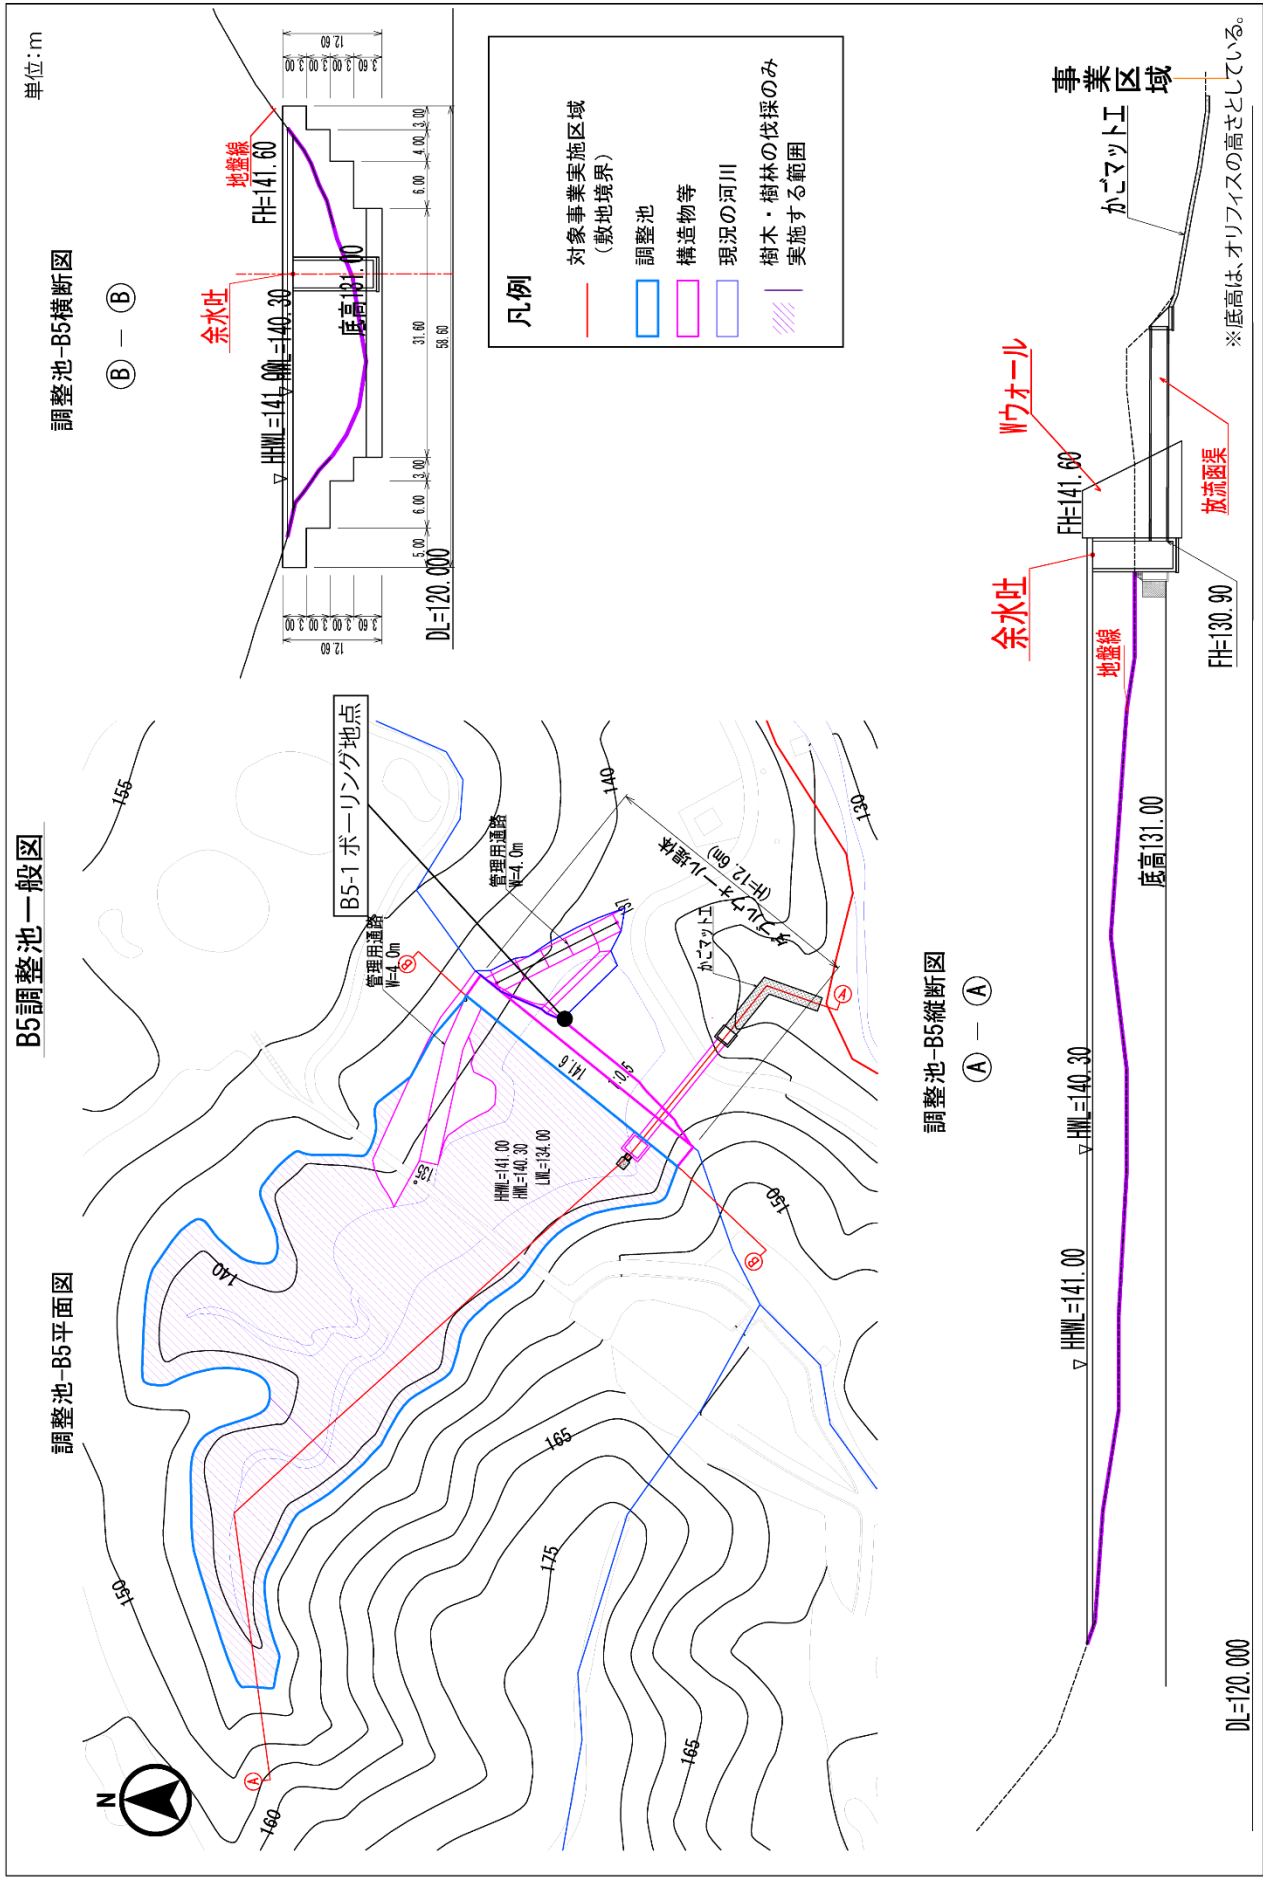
(8) 調整池の平面図・断面図 (B5)
